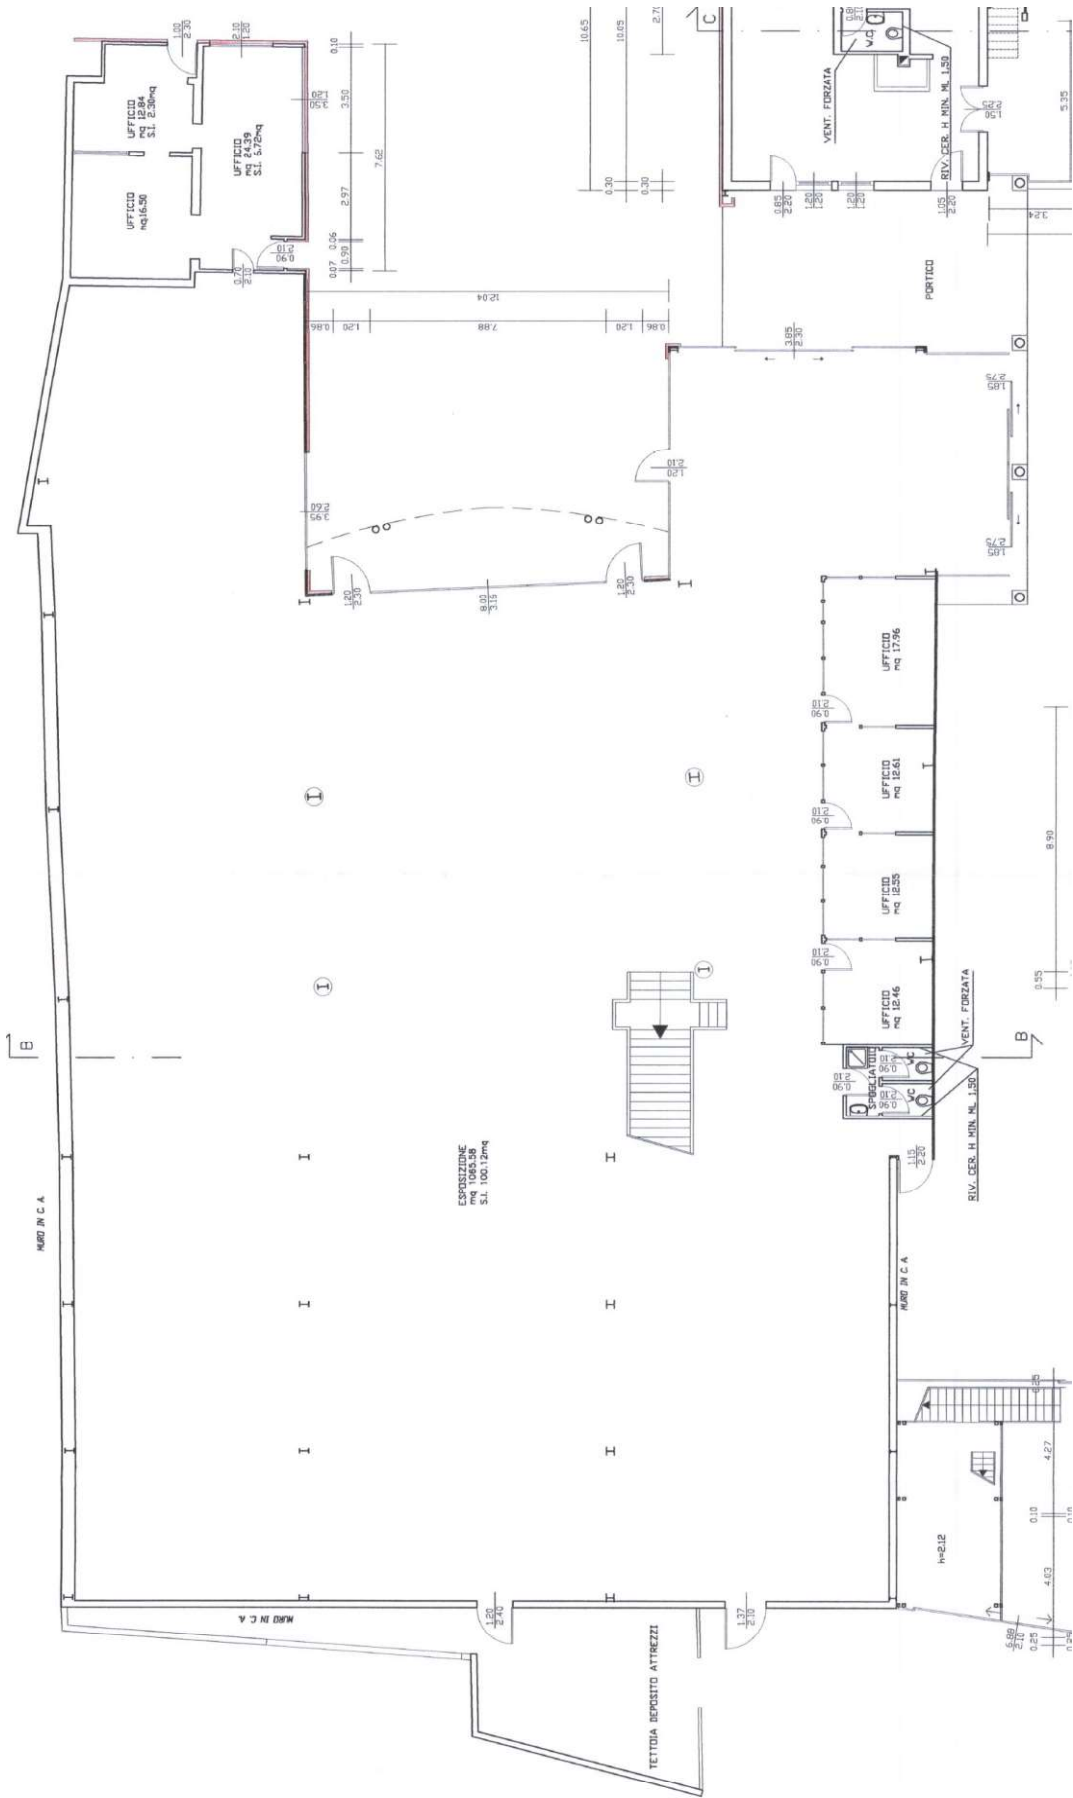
schema a vista pianta piano primo CAPANNONE (fuori scala)
